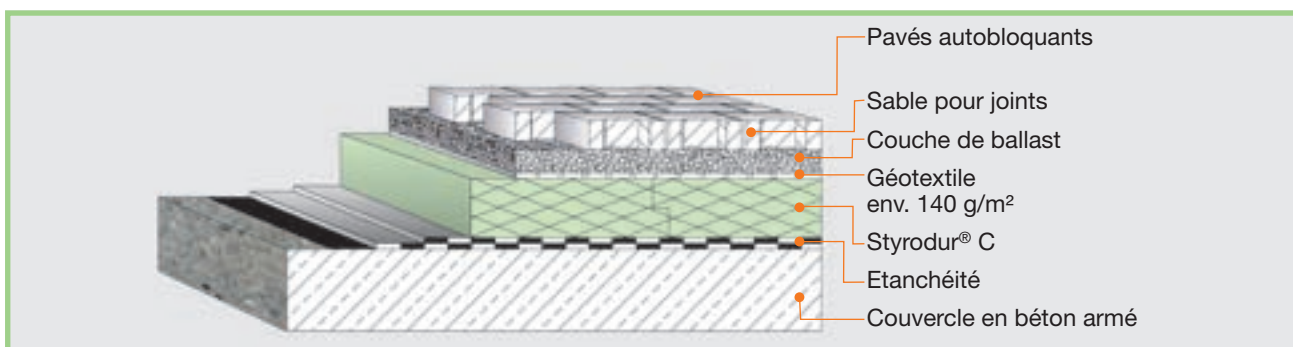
Toiture en parking avec pavés autobloquants sur une couche de ballast.
